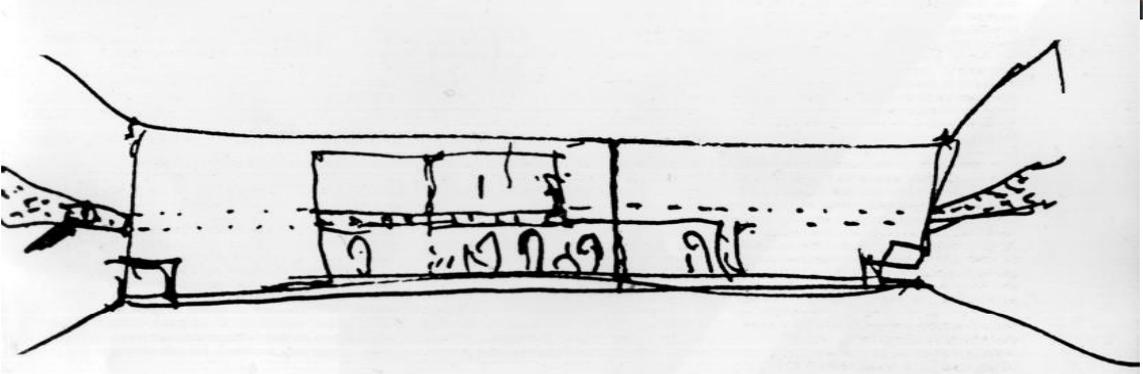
Francesco Venezia, La Stadhalle a Regensburg, 1987, planimetria generale.
